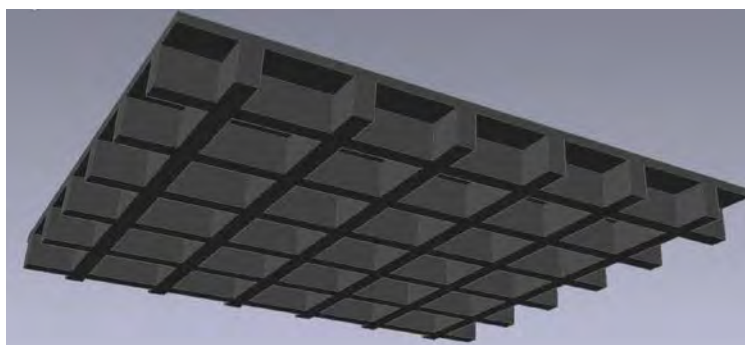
Losa Nervada de Concreto Armado. Fuente: Google imágenes.
